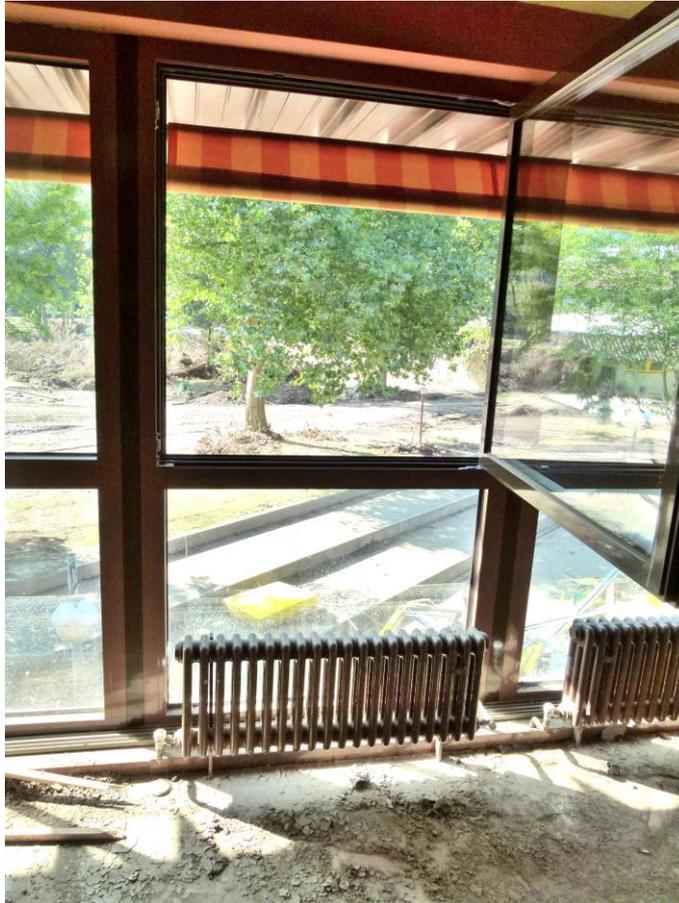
A - Fensterelement Lehrerzimmer Südfassade
